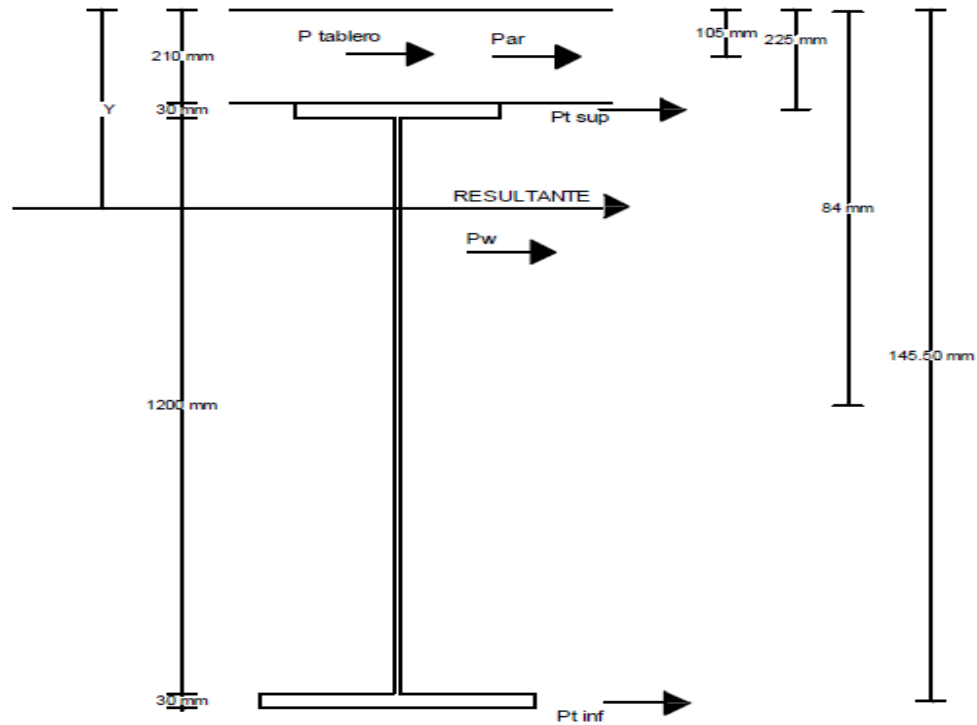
Eje neutro plástico ubicado en el alma de la viga. Elaborado por: Autor
